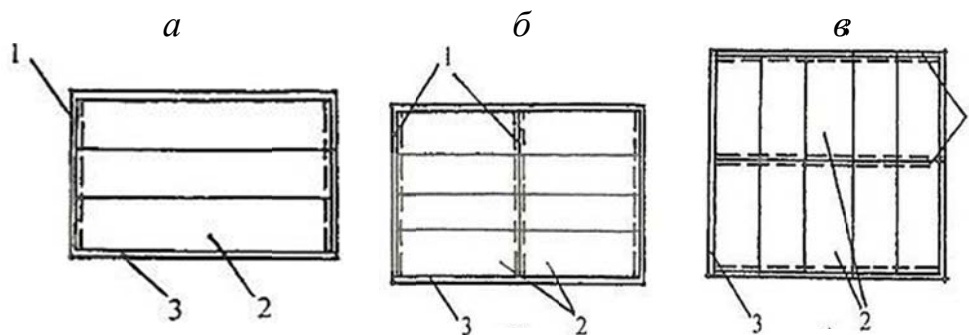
Бескаркасные конструктивные системы и схемы:
